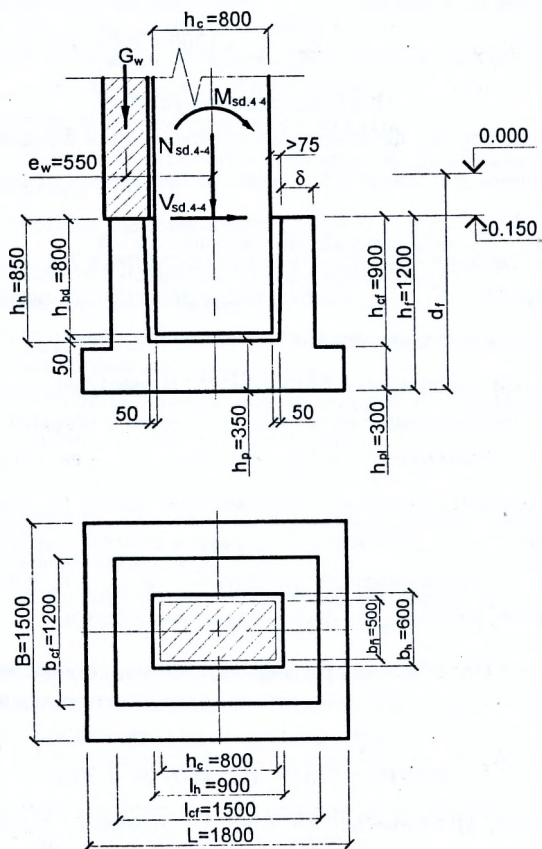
Конструкция фундамента под крайнюю колонну
